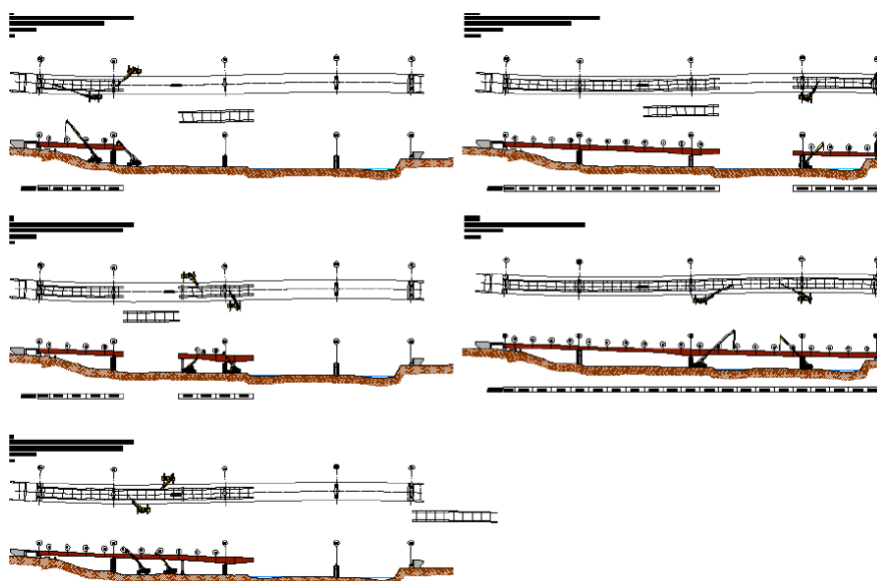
Cantiere Varo viadotto sul fiume Ellero
